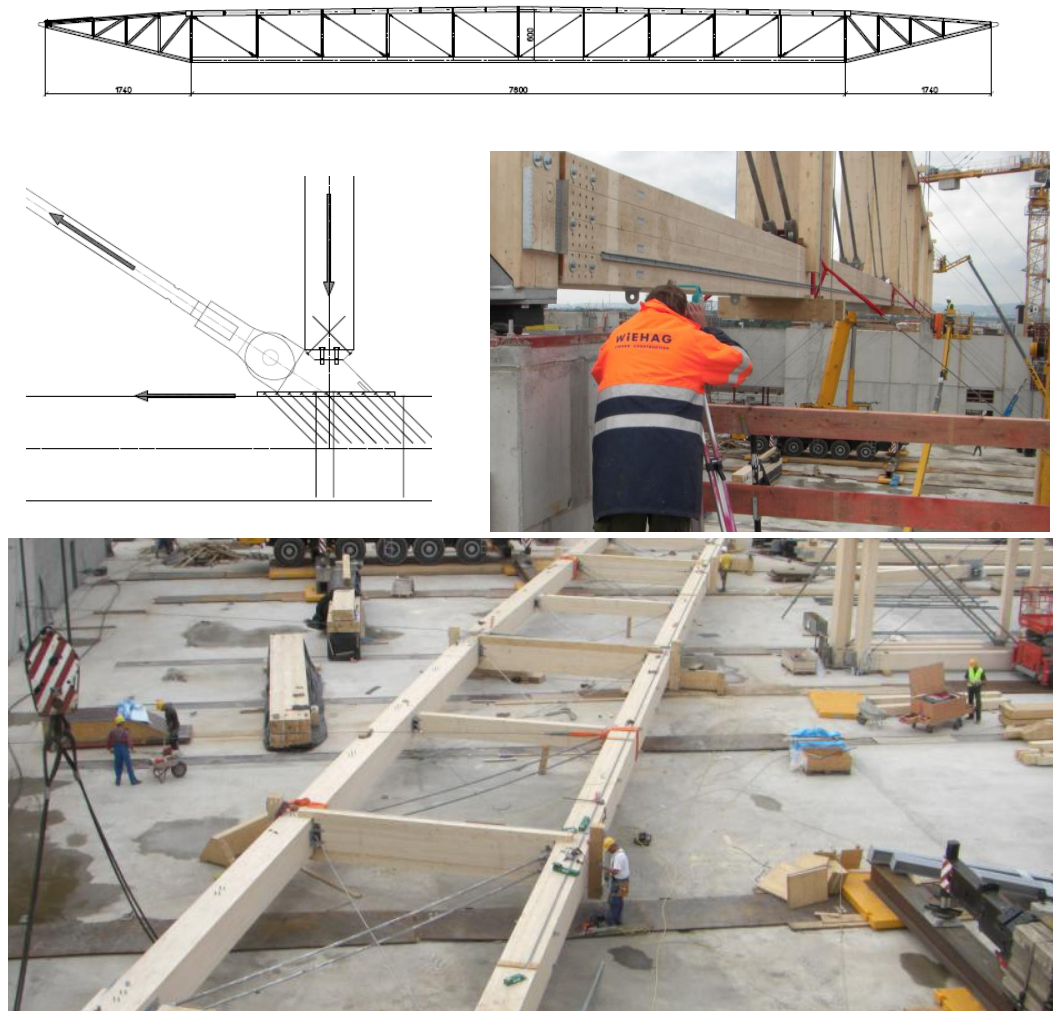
Systemansicht Fachwerk (oben); Knotendetail eines Anschlusses (Mitte links); Montage der Fachwerkträger (Mitte rechts); Zusammenbau der Fachwerke am Boden (unten) [35]
